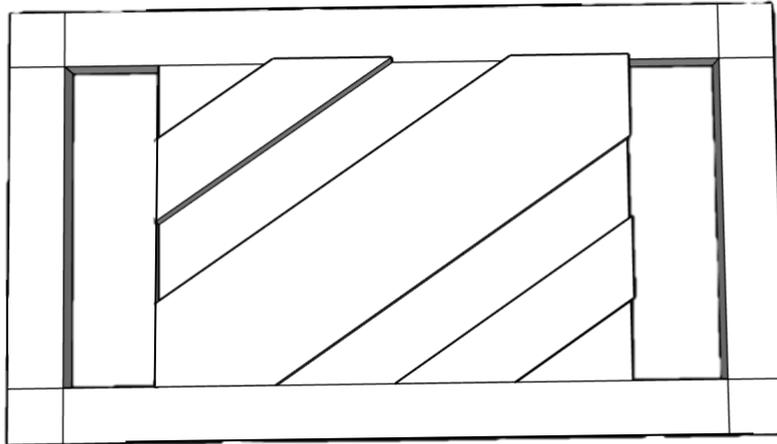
Planta zapata metálica derecha. Elaboración propia
